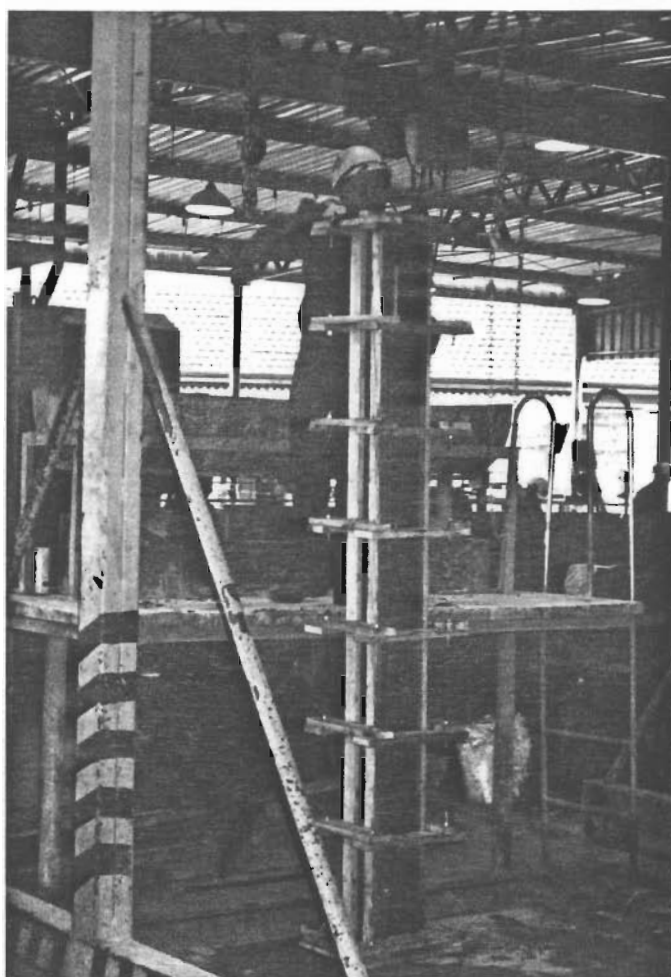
Fôrma vertical de madeira para produção de pilares.
